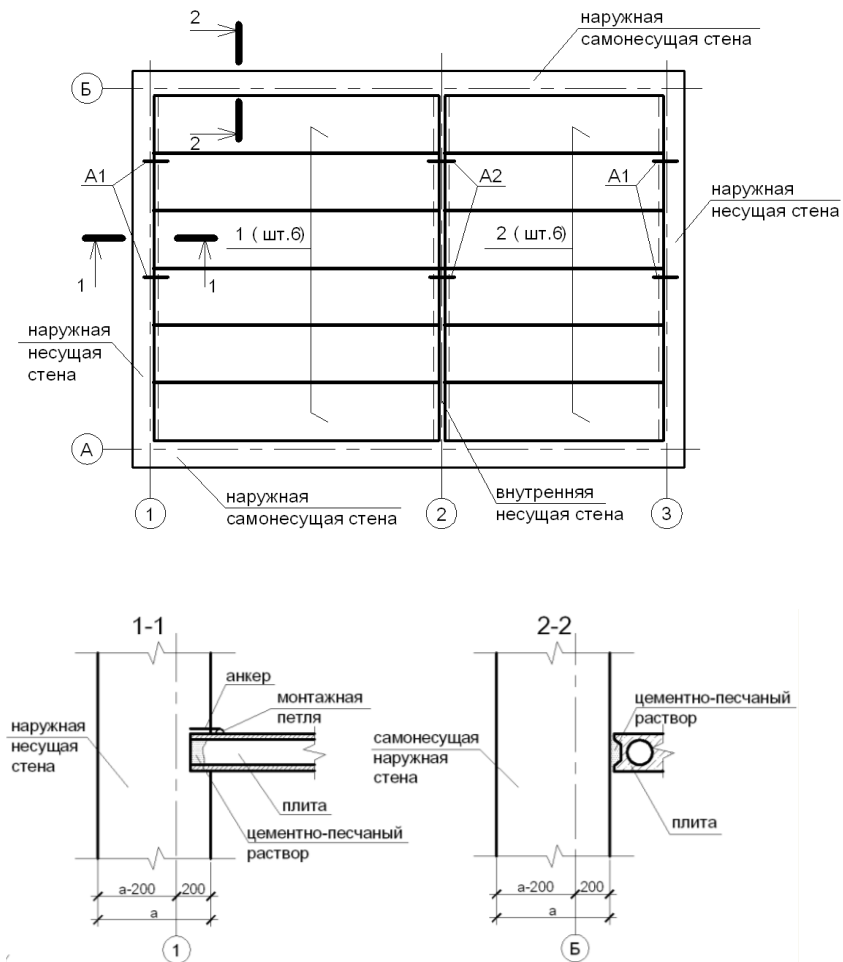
Бескаркасная система здания с поперечным расположением несущих стен
